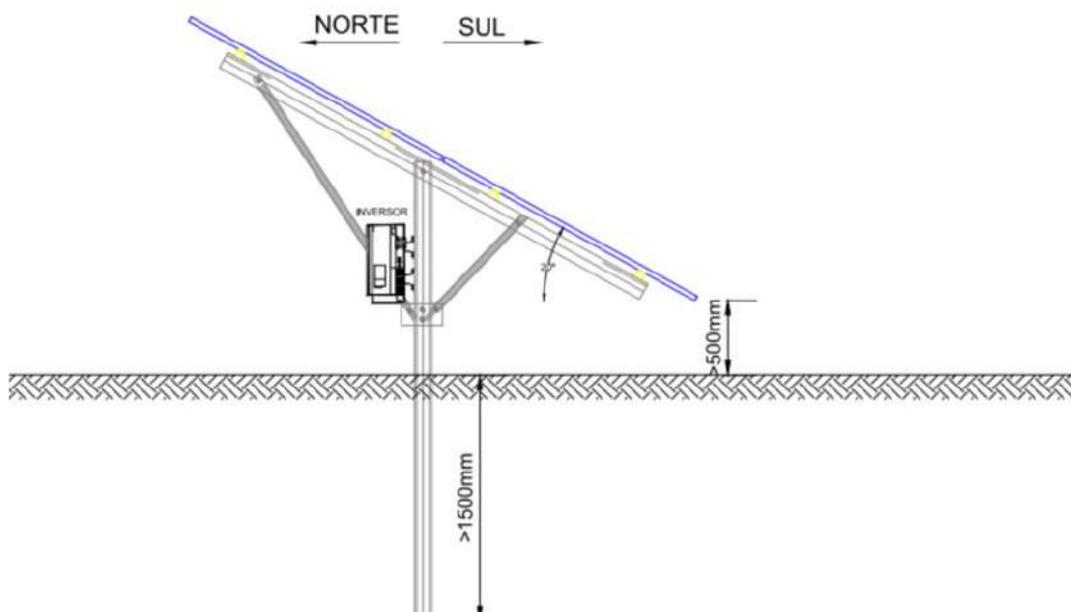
A – Estruturas metálicas de suporte de módulos PV, com estacaria em solo
